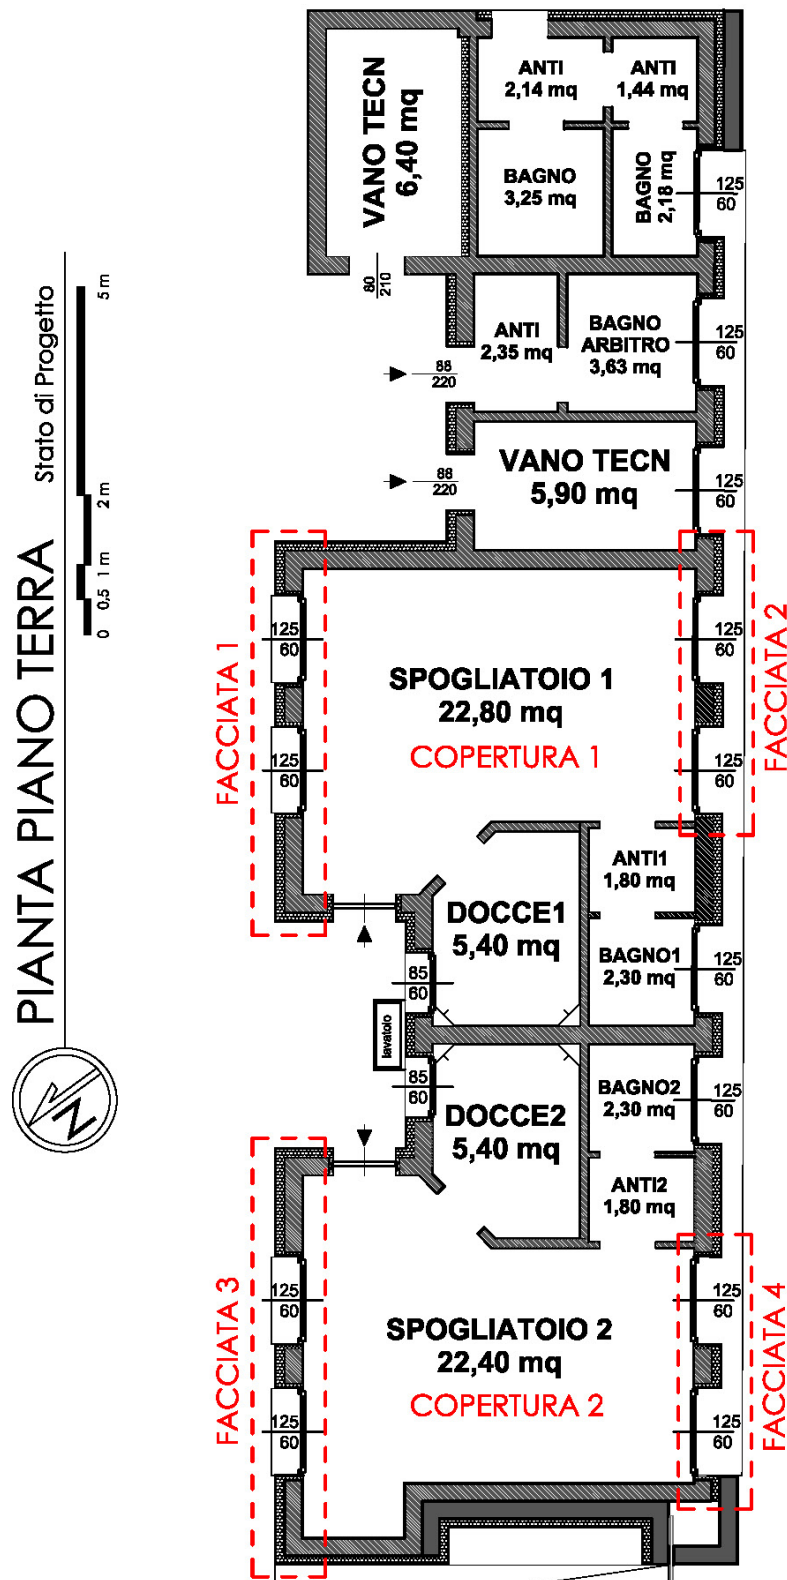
pianta del piano terra dello stato di progetto con indicazione delle facciate più critiche oggetto di valutazione
